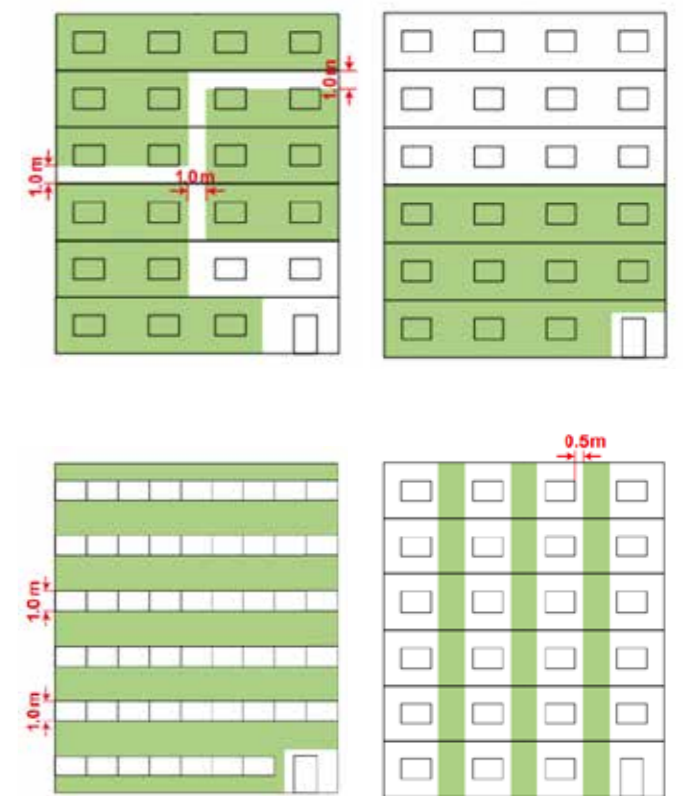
Erstreckung über maximal 3 Geschosse, Teilflächenabstand mindestens 1 m, Abstand zu Fenstern mindestens 0.5 m, an feuerwiderstandsfähiger Aussenwand oder Sprinkleranlagen in mit Öffnung angrenzenden Räumen (© VKF Brandschutzmerkblatt Gebäudebegrünungen, 2024)
